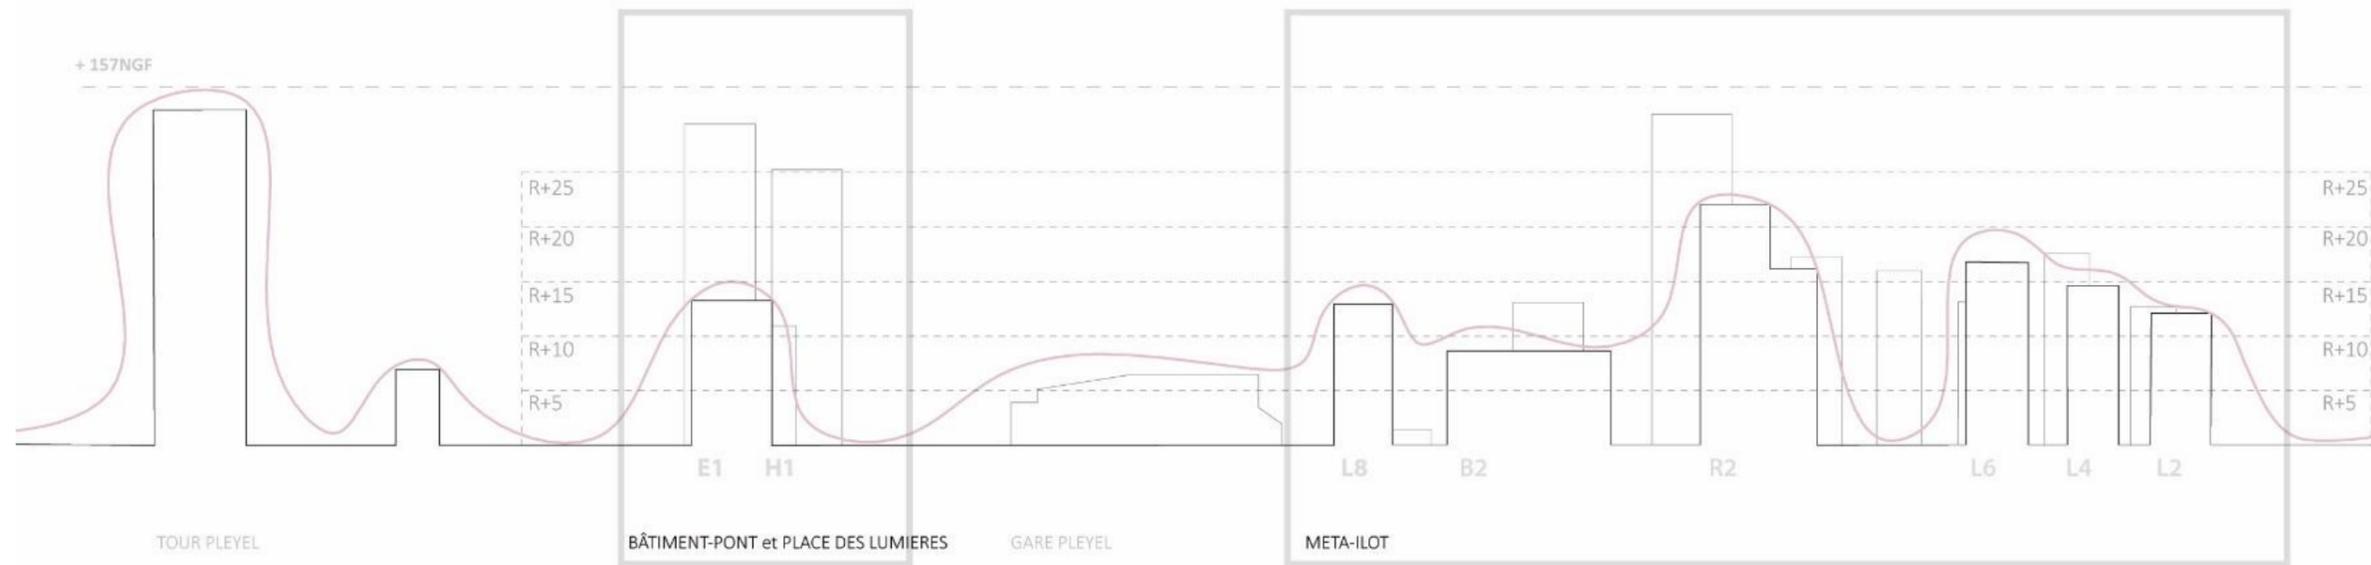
Schéma général d'épannelage des hauteurs des constructions (« vague urbaine »), Vue Sud-Nord, depuis la voie ferrée – Emprise et gabarit des constructions indicatifs
